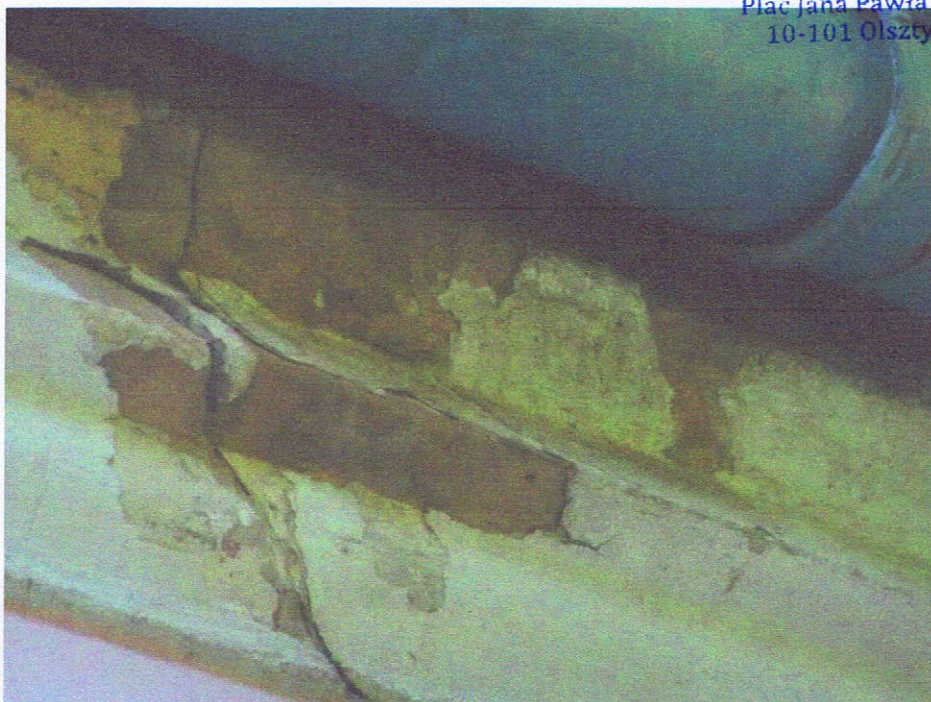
Elewacja podwórzowa – wtórne okno piętra ryzalitu
